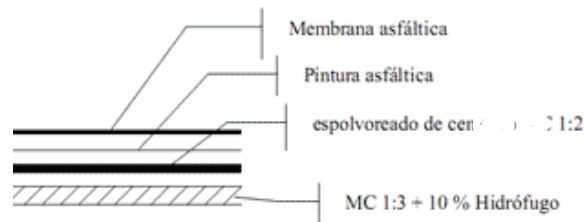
Partes de una capa aisladora. (Apuntes Ingeniería Civil, 2013)
